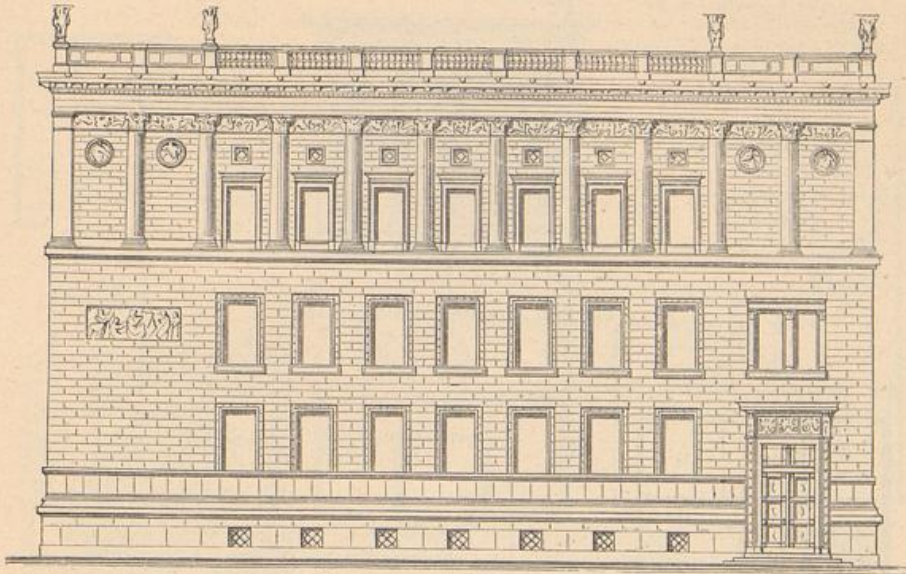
Bier'sches Wohnhaus, Leipziger Platz No. 11\* (Archit. Strack.)
